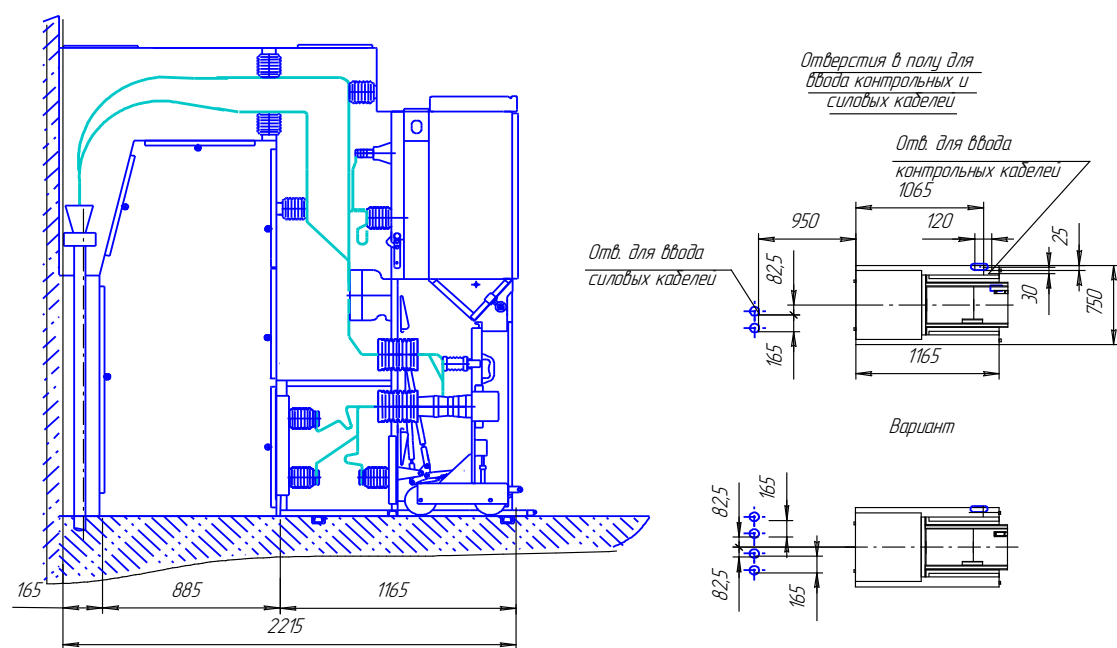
Установка шкафа с кабельным вводом снизу вне шкафа на фундамент
